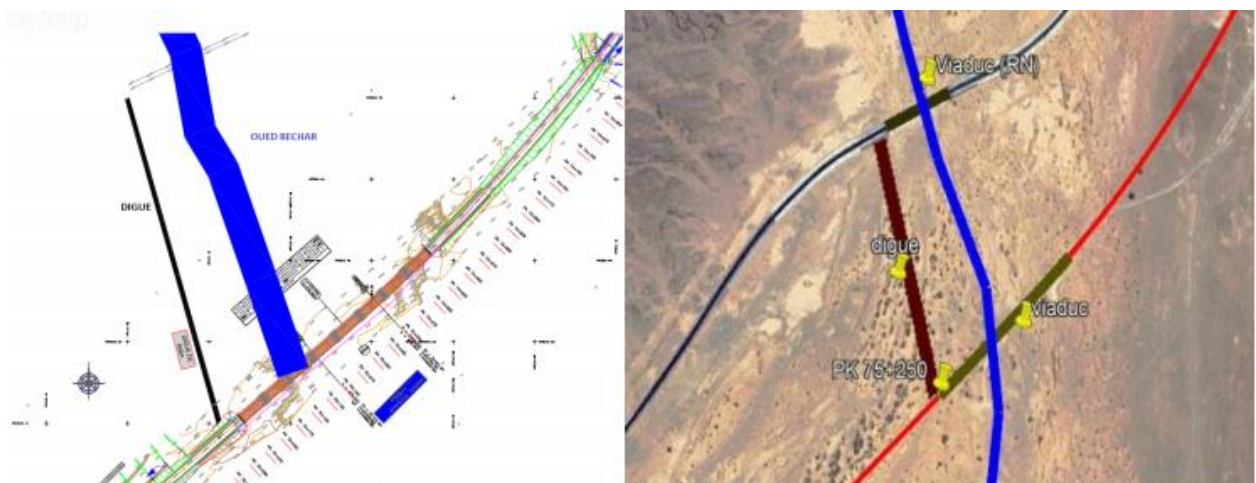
VUE EN PLANS D'OUED BECHAR TRAVERSANT LE TRACÉ AU PK 75+100
